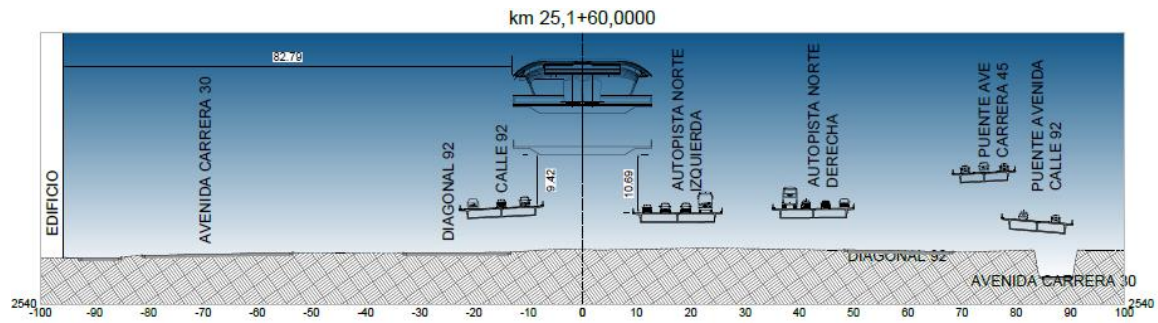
Sección transversal de nivel plataforma y mezzanina superior en PK 25+160
